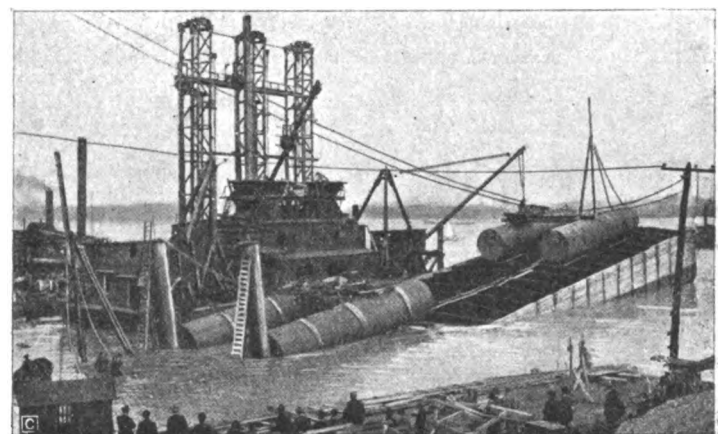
a 42. — Tunnel sotto il Detroit River.
